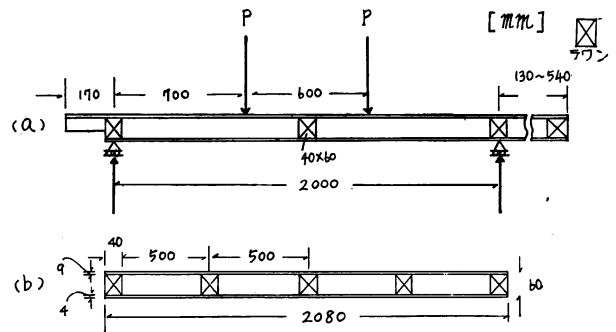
妻パネルの断面構成、寸法および曲げ試験方法
